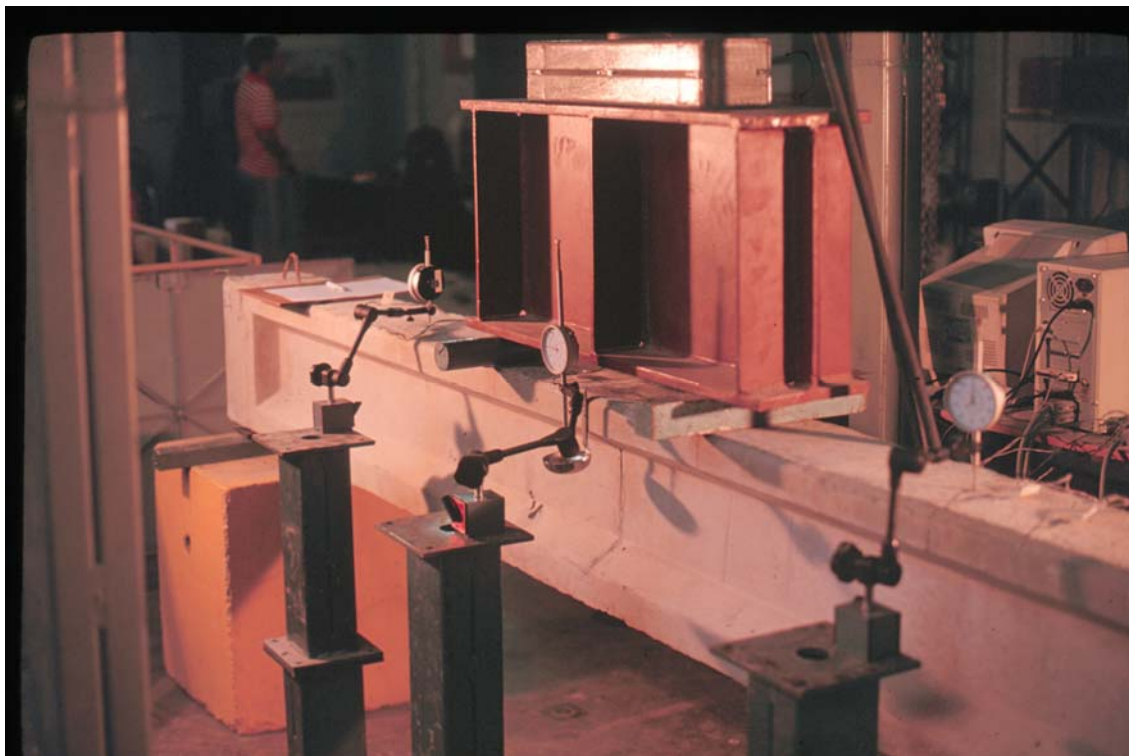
Detalhe de uma viga na posição de ensaio
